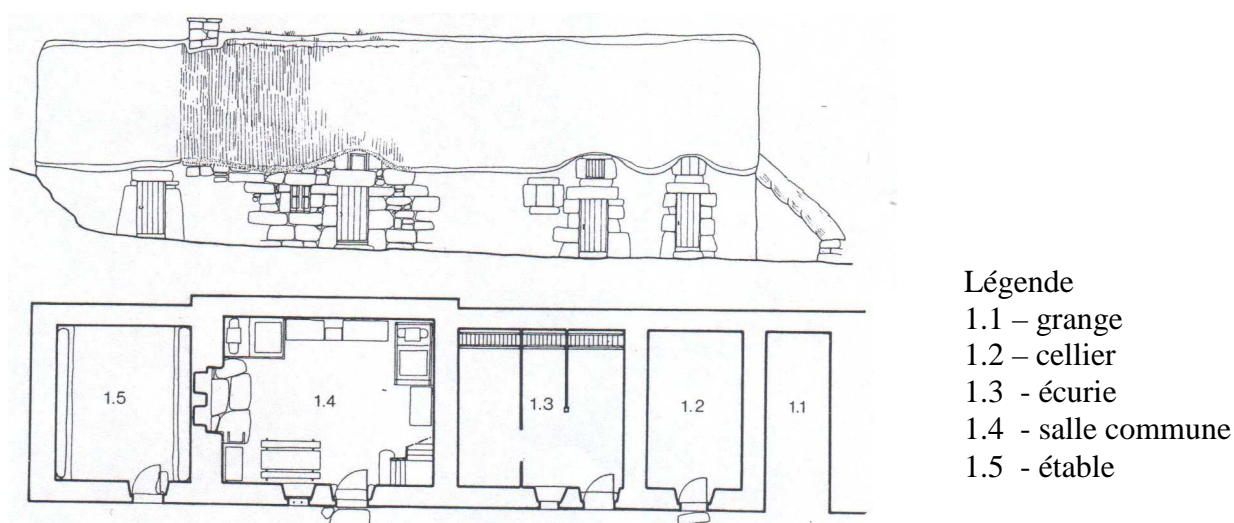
Façade et plan d'une maison pluricellulaire à plusieurs portes
